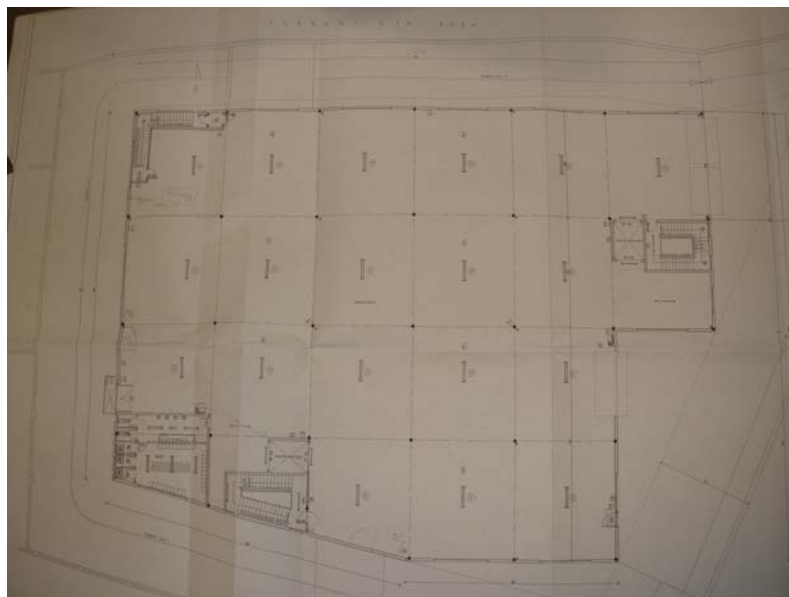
Plano original de la planta baja del edificio almacén
